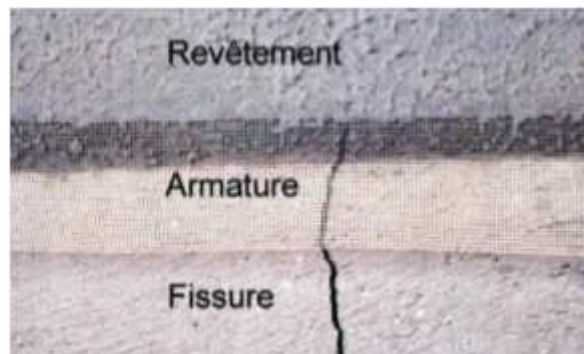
Pontage d'une fissure avec incorporation d'une armature. [17]
